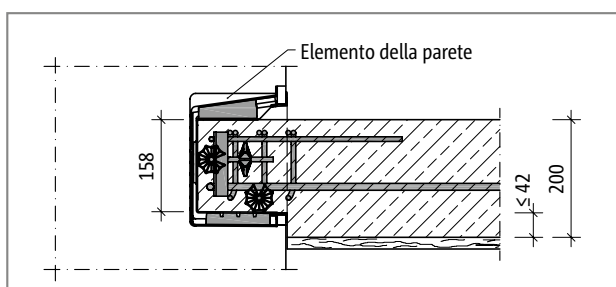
Schöck Tronsole® tipo Z, elemento previsto con cassero a perdere; l'intradosso del solaio più basso dell'elemento.
